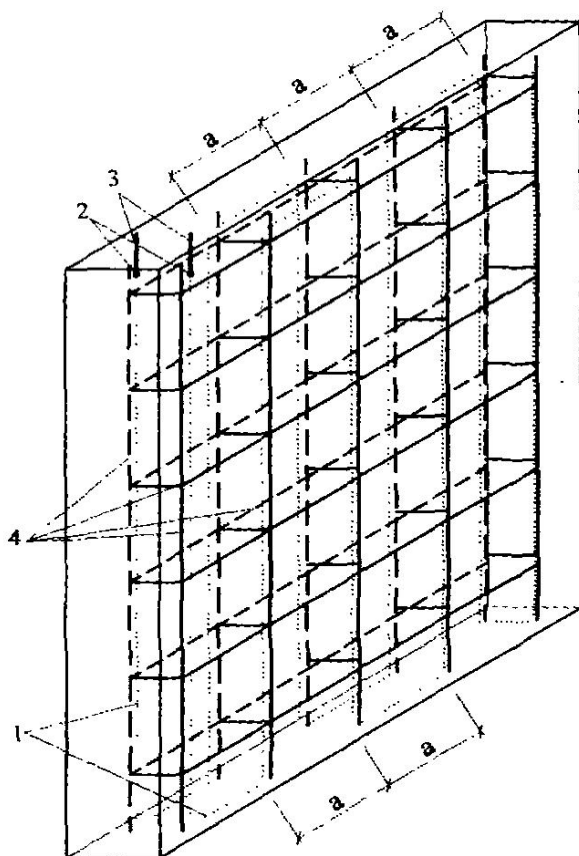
Схема раскладки греющего провода при возведении стены.
